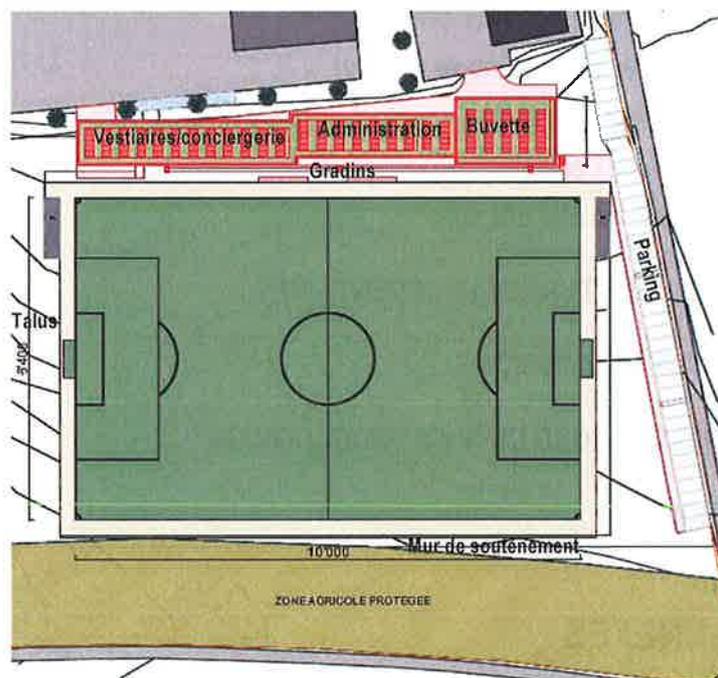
Plan de situation du terrain de foot et des bâtiments
